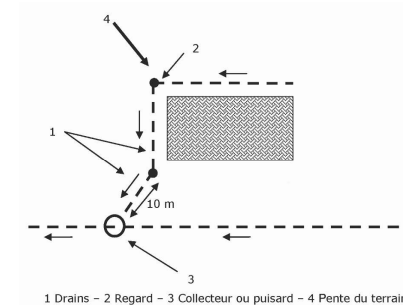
Illustration du réseau de drainage (drain et tranchée drainante) sur terrain en pente (NF DTU 20.1)
